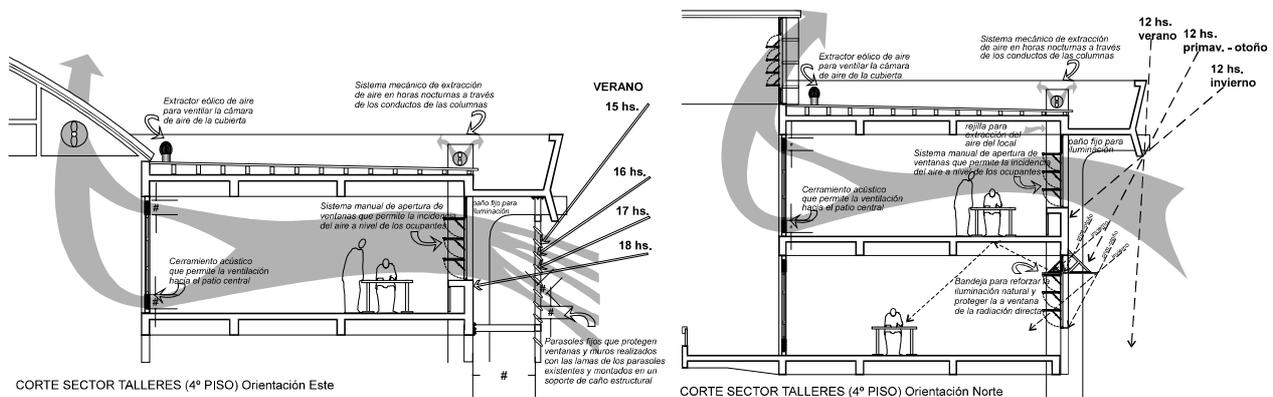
Corte del sector de talleres con los sistemas de ventilación, protecciones solares y materiales constructivos.
